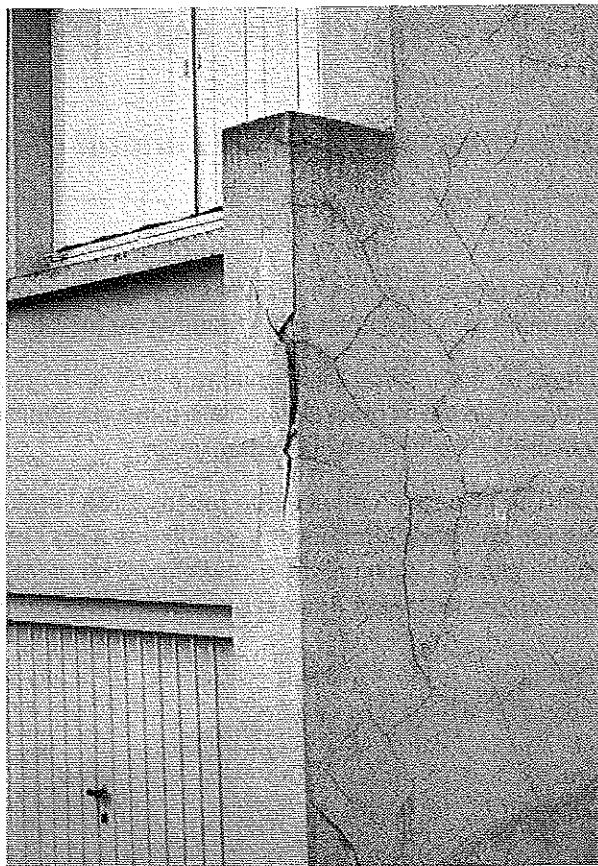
Détail fissurations avec décollement près d'une arête. © J. Putatti
